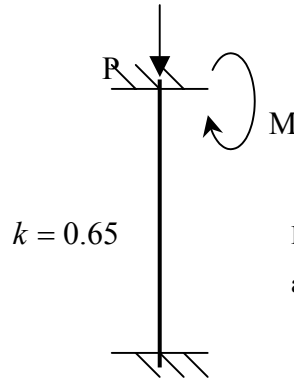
Esquema de las fuerzas actuantes en la columna.
